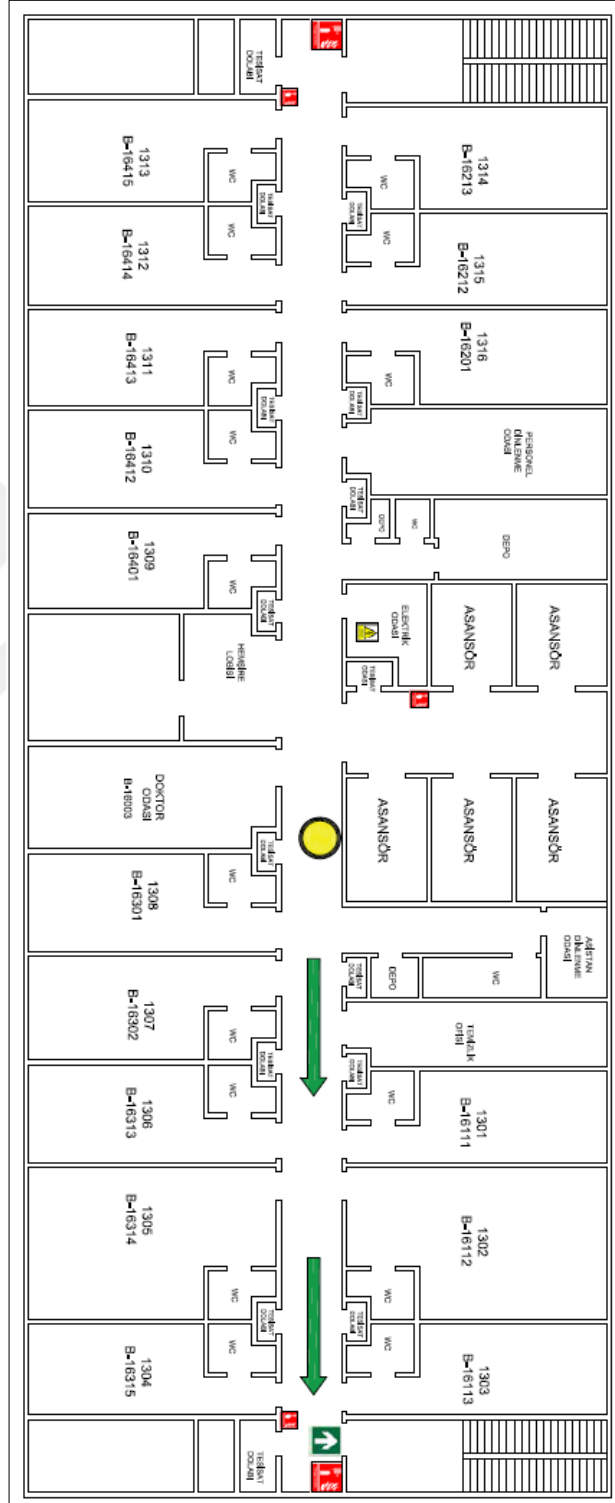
Dr. Siyami Ersek Hastanesi 1/500 vaziyet planı
